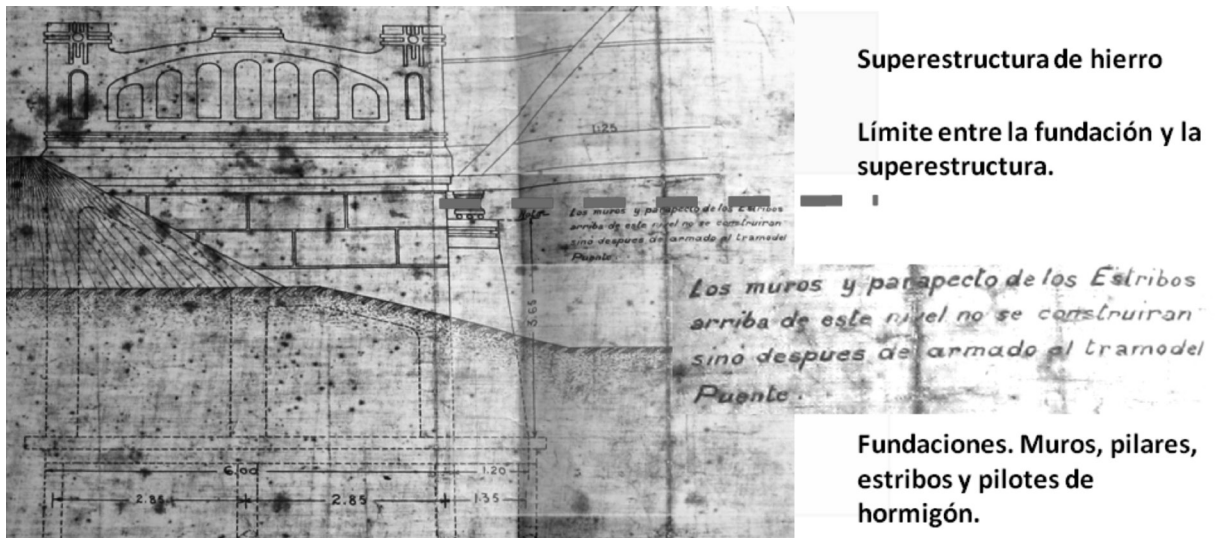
Planos de obra. Sección Transversal. Fuente: Dirección de Hidráulica Sección Dolores.
